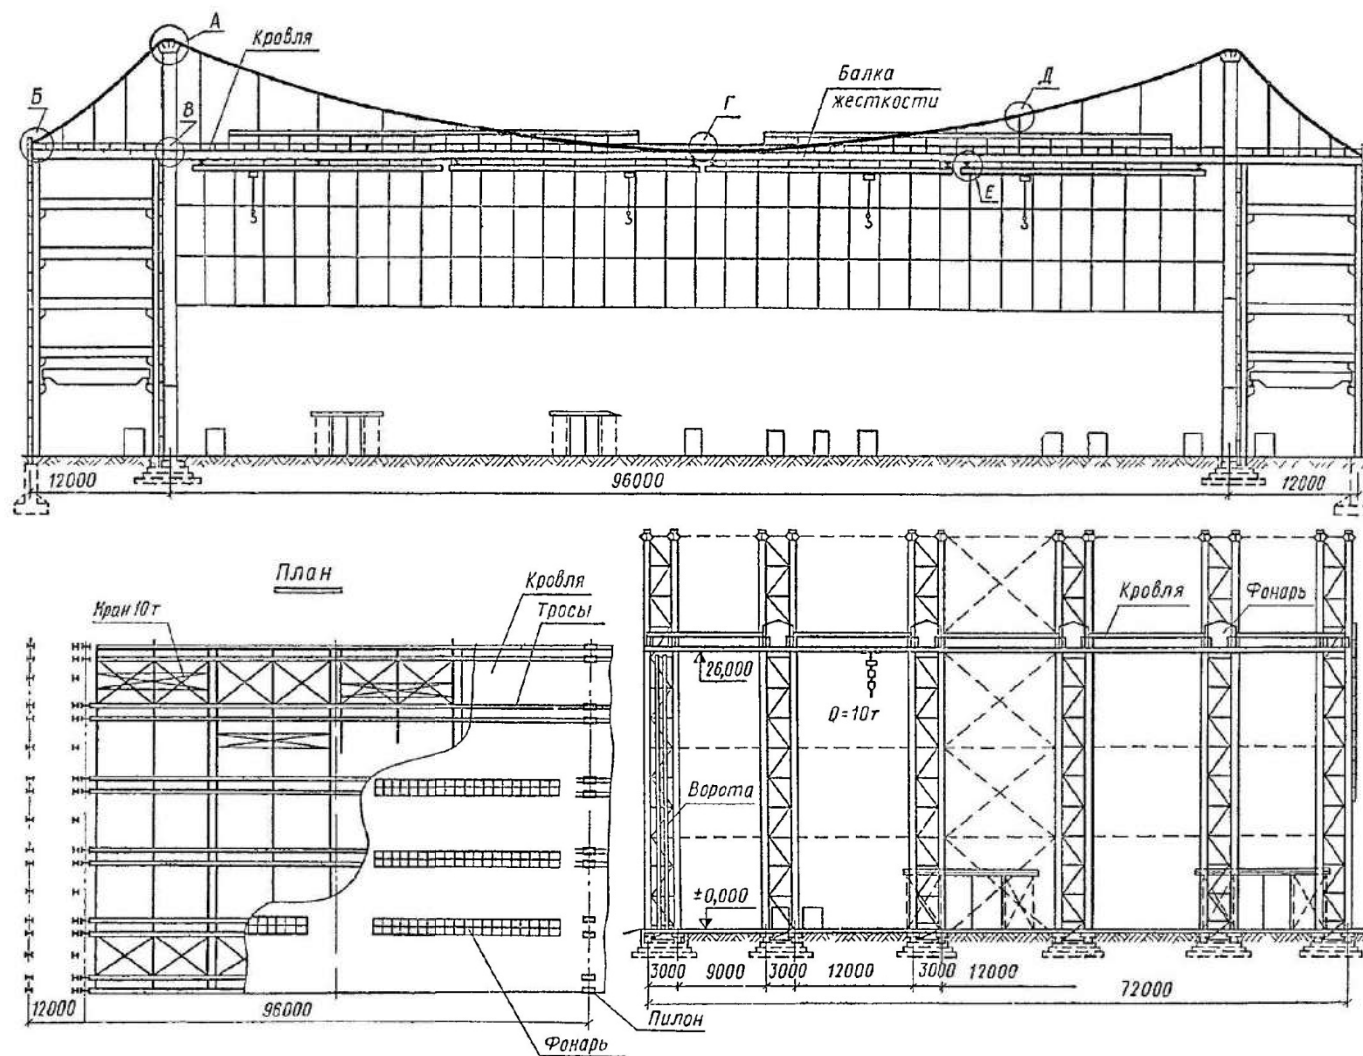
, а. Промышленное здание с висячим покрытием. План, разрез
